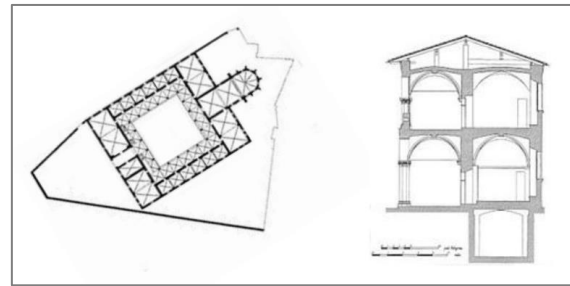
Plano planta baja y corte transversal Colegio Bolonia.
